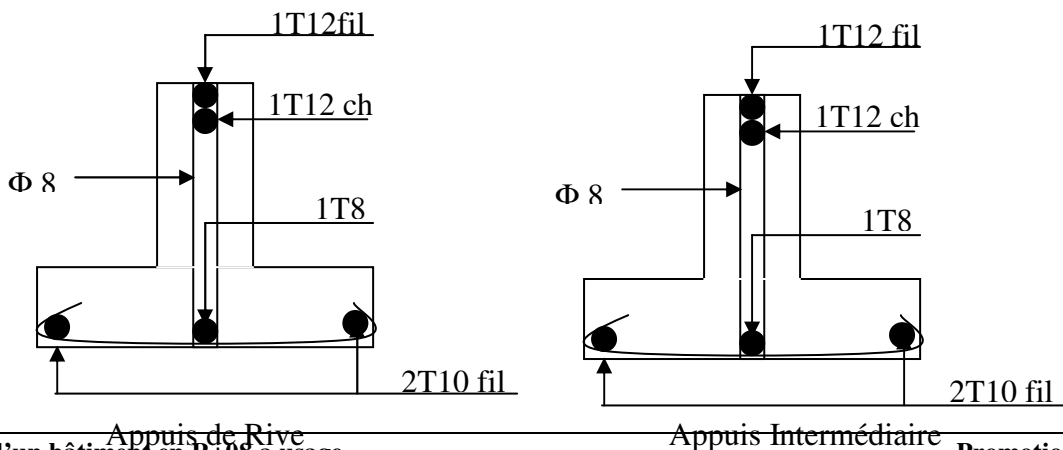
c: Schéma de disposition du ferrailage des poutrelles Plancher haut RDC et 1^{er}. Etage
